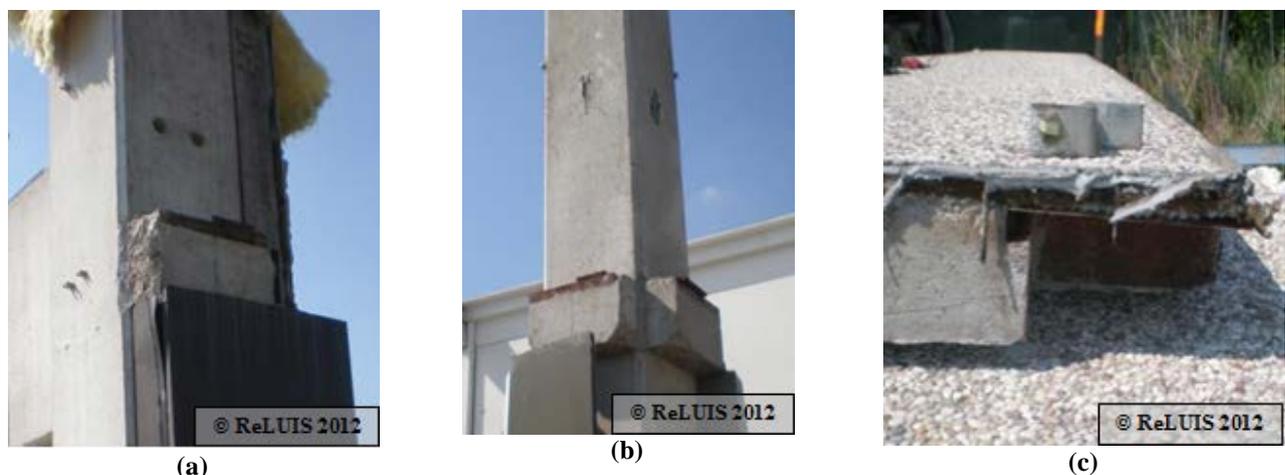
Particolare della connessione al pilastro del pannello di tamponatura orizzontale nella sua parte inferiore: (a e b) sella nel pilastro e (c) sagomatura del pannello orizzontale per realizzare l'appoggio
